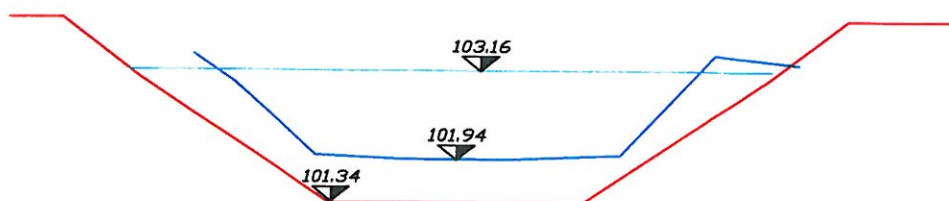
Esempio raffigurante alcune sezioni reisezionate tra la sez. 45 e la sez. 230
